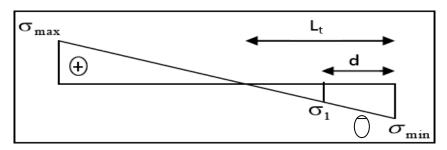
Diagramme d'une section partiellement comprimée.
